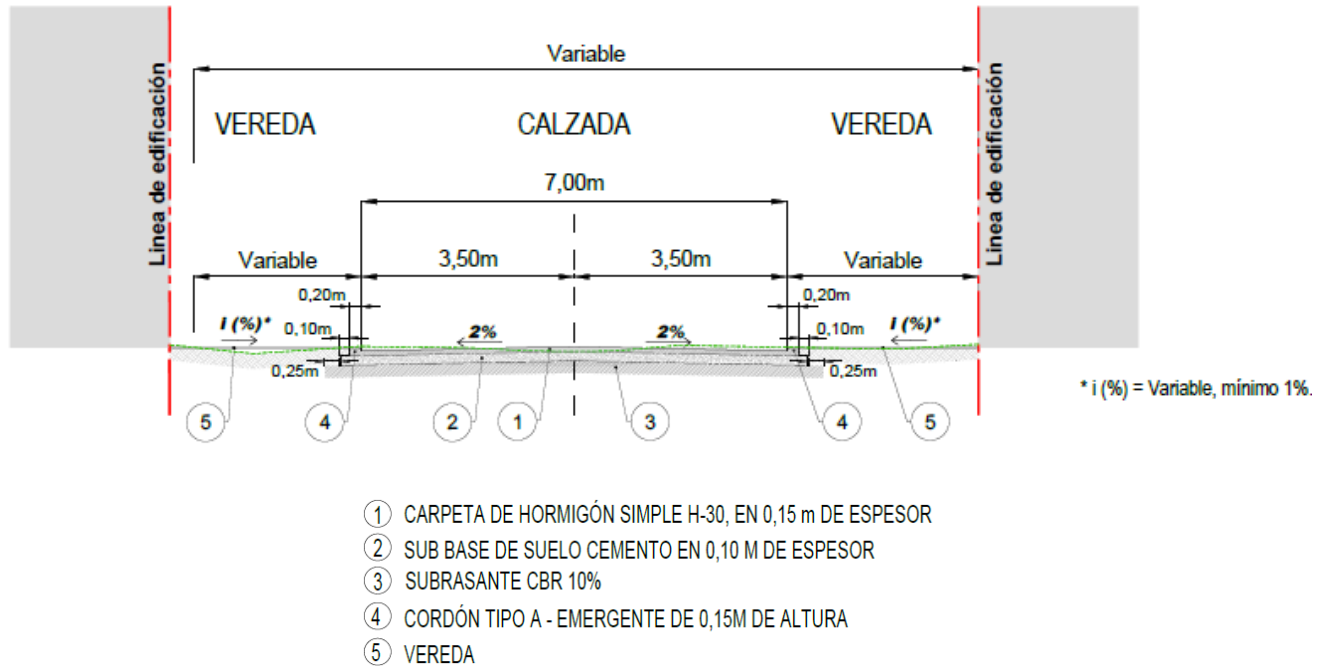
Perfil tipo N°2 - Calle Tokio.
